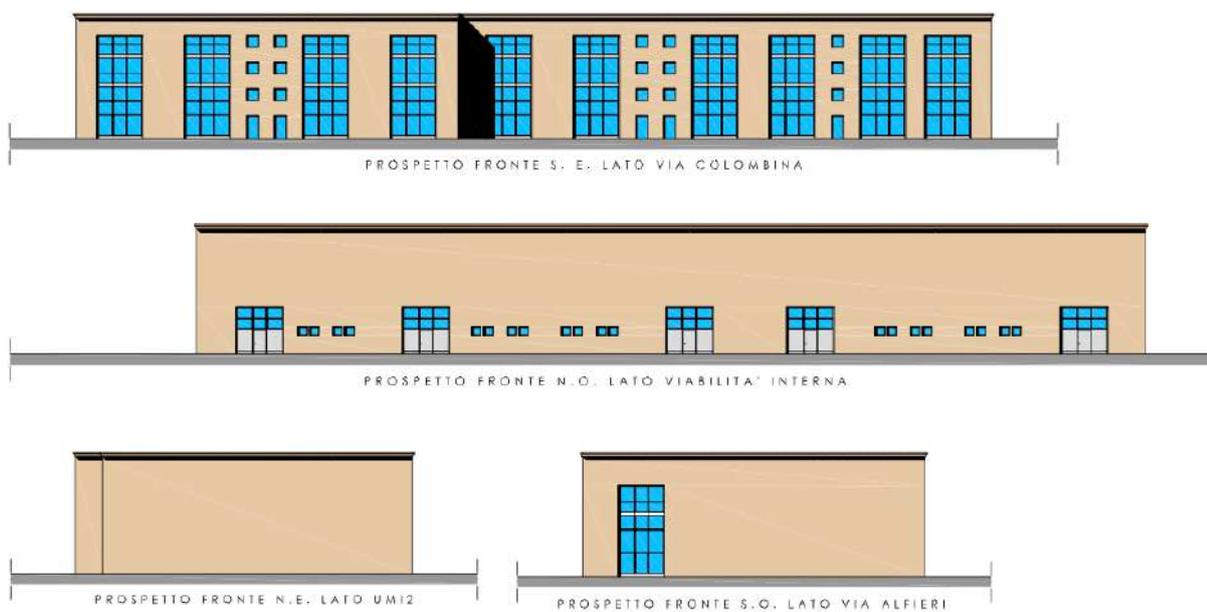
Estratto dell'elaborato del PA E8/B – Prospetti e sezioni edificio A
